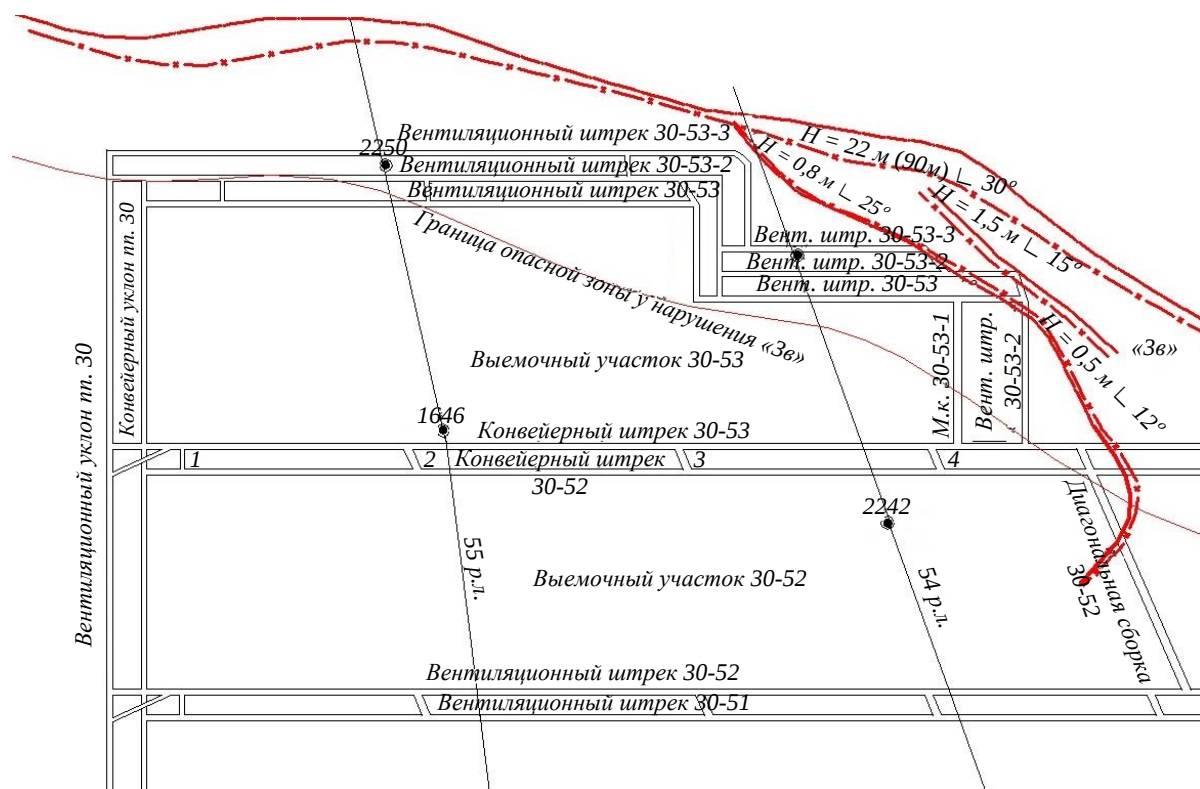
Выкопировка из плана горных выработок по пласту 30
